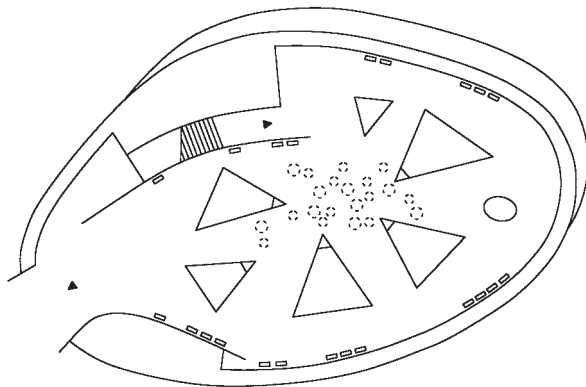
Grundriss der Ostsee-Ausstellung: Raumbild „Ostsee – das Meer vor der Haustür Stralsunds. Maßstäblichkeit und Ausstellungseinbauten rücken
